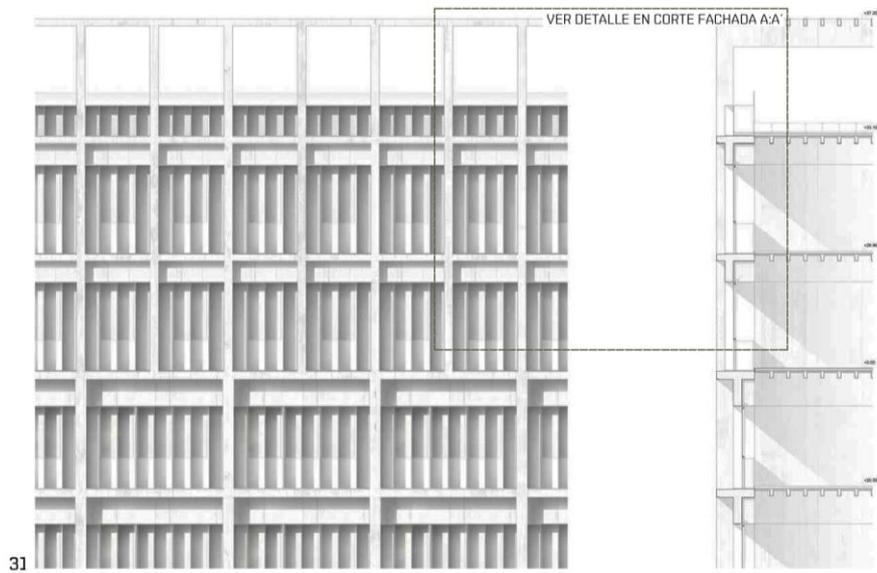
Detalle constructivo de fachada portante SV. Elaborado por: María Beatriz
